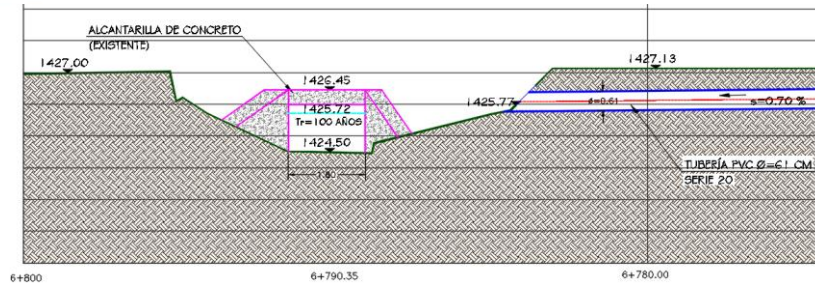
Descarga a la alcantarilla existente en la zona federal del arroyo
